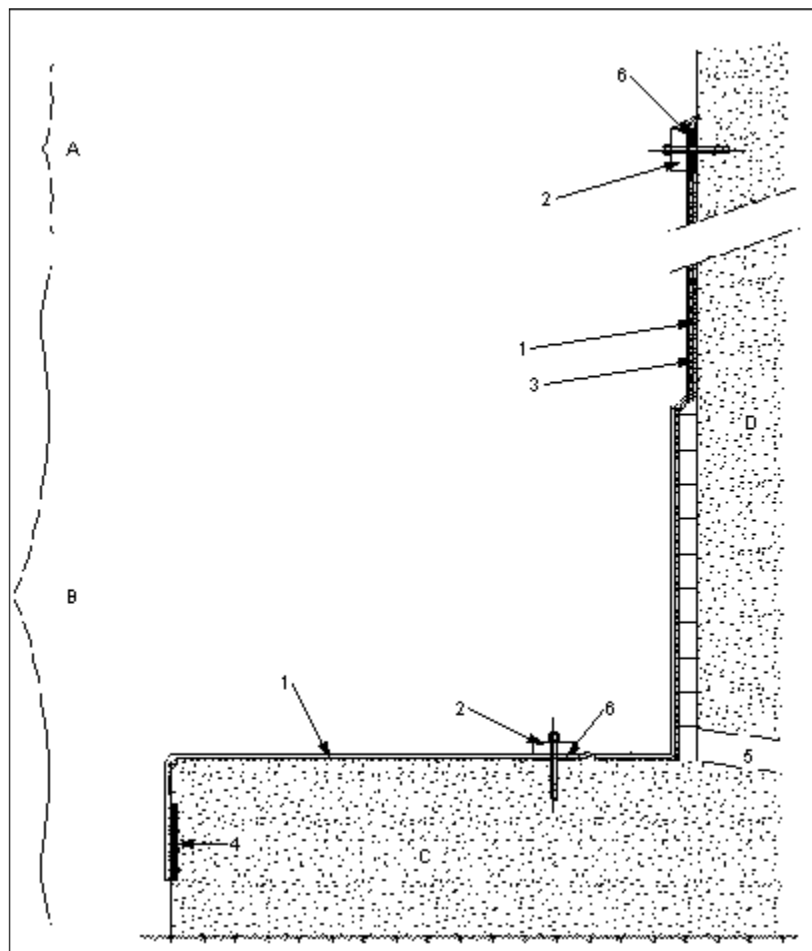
détails de fixation du complexe géotextile-géomembrane en crête et en pied du Barrage de l'Echape.
